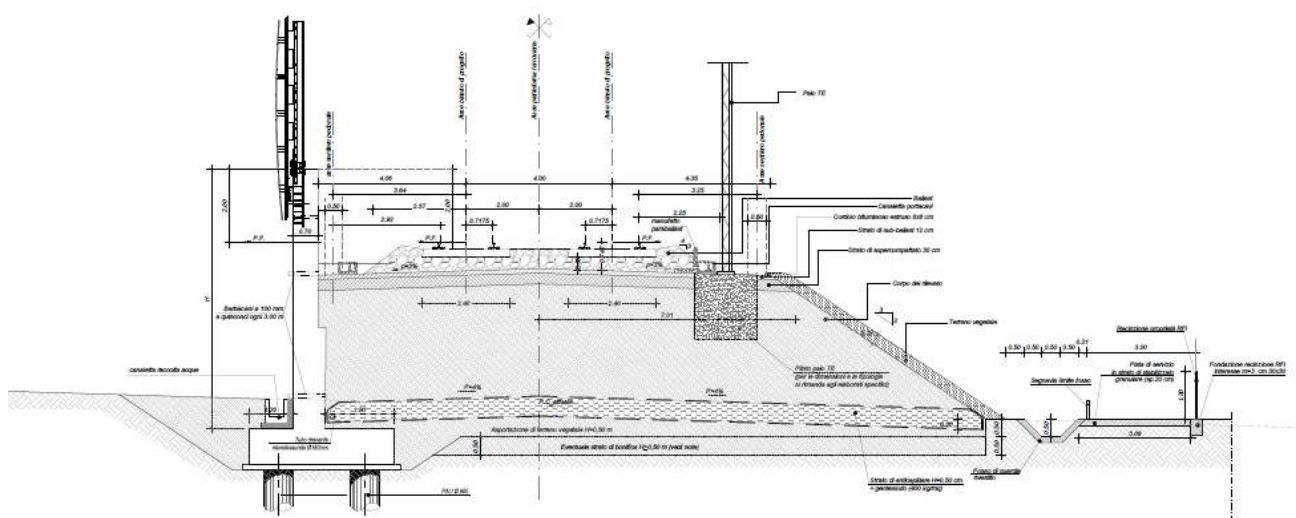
Sezione tipo ferroviaria in rilevato con muro di sottoscampa con barriera antirumore
